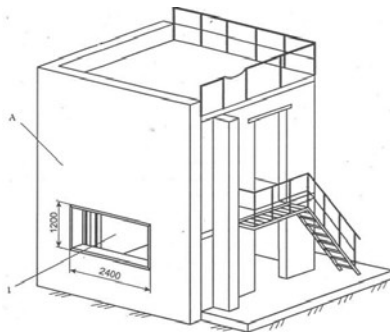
Фрагмент будинку: А – стіна, яка призначена для монтажу фасаду, 1 – віконний проріз
